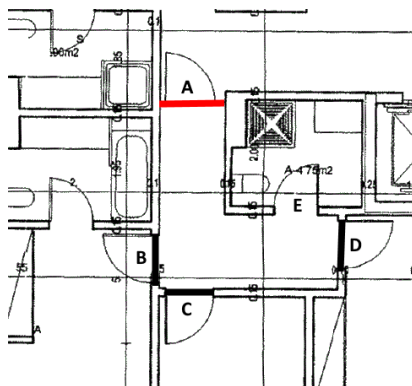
Excerto da planta do L12 onde foi realizado o ensaio da porta ventiladora (A - Porta Ventiladora; B-D - Quarto 1-3; E - Porta da IS)
